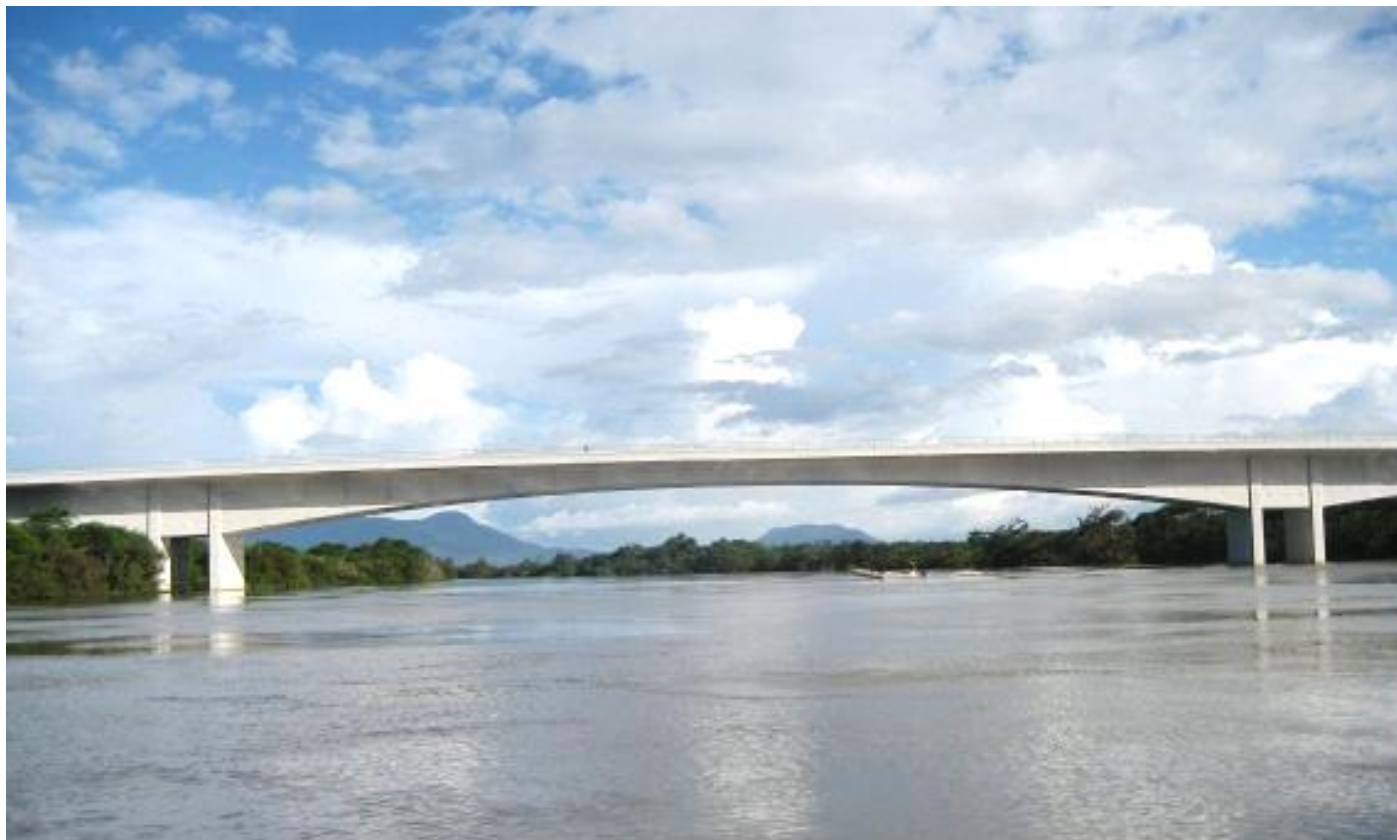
Ponte Pref. Olavo B. Filho (Arteleste Construções)
